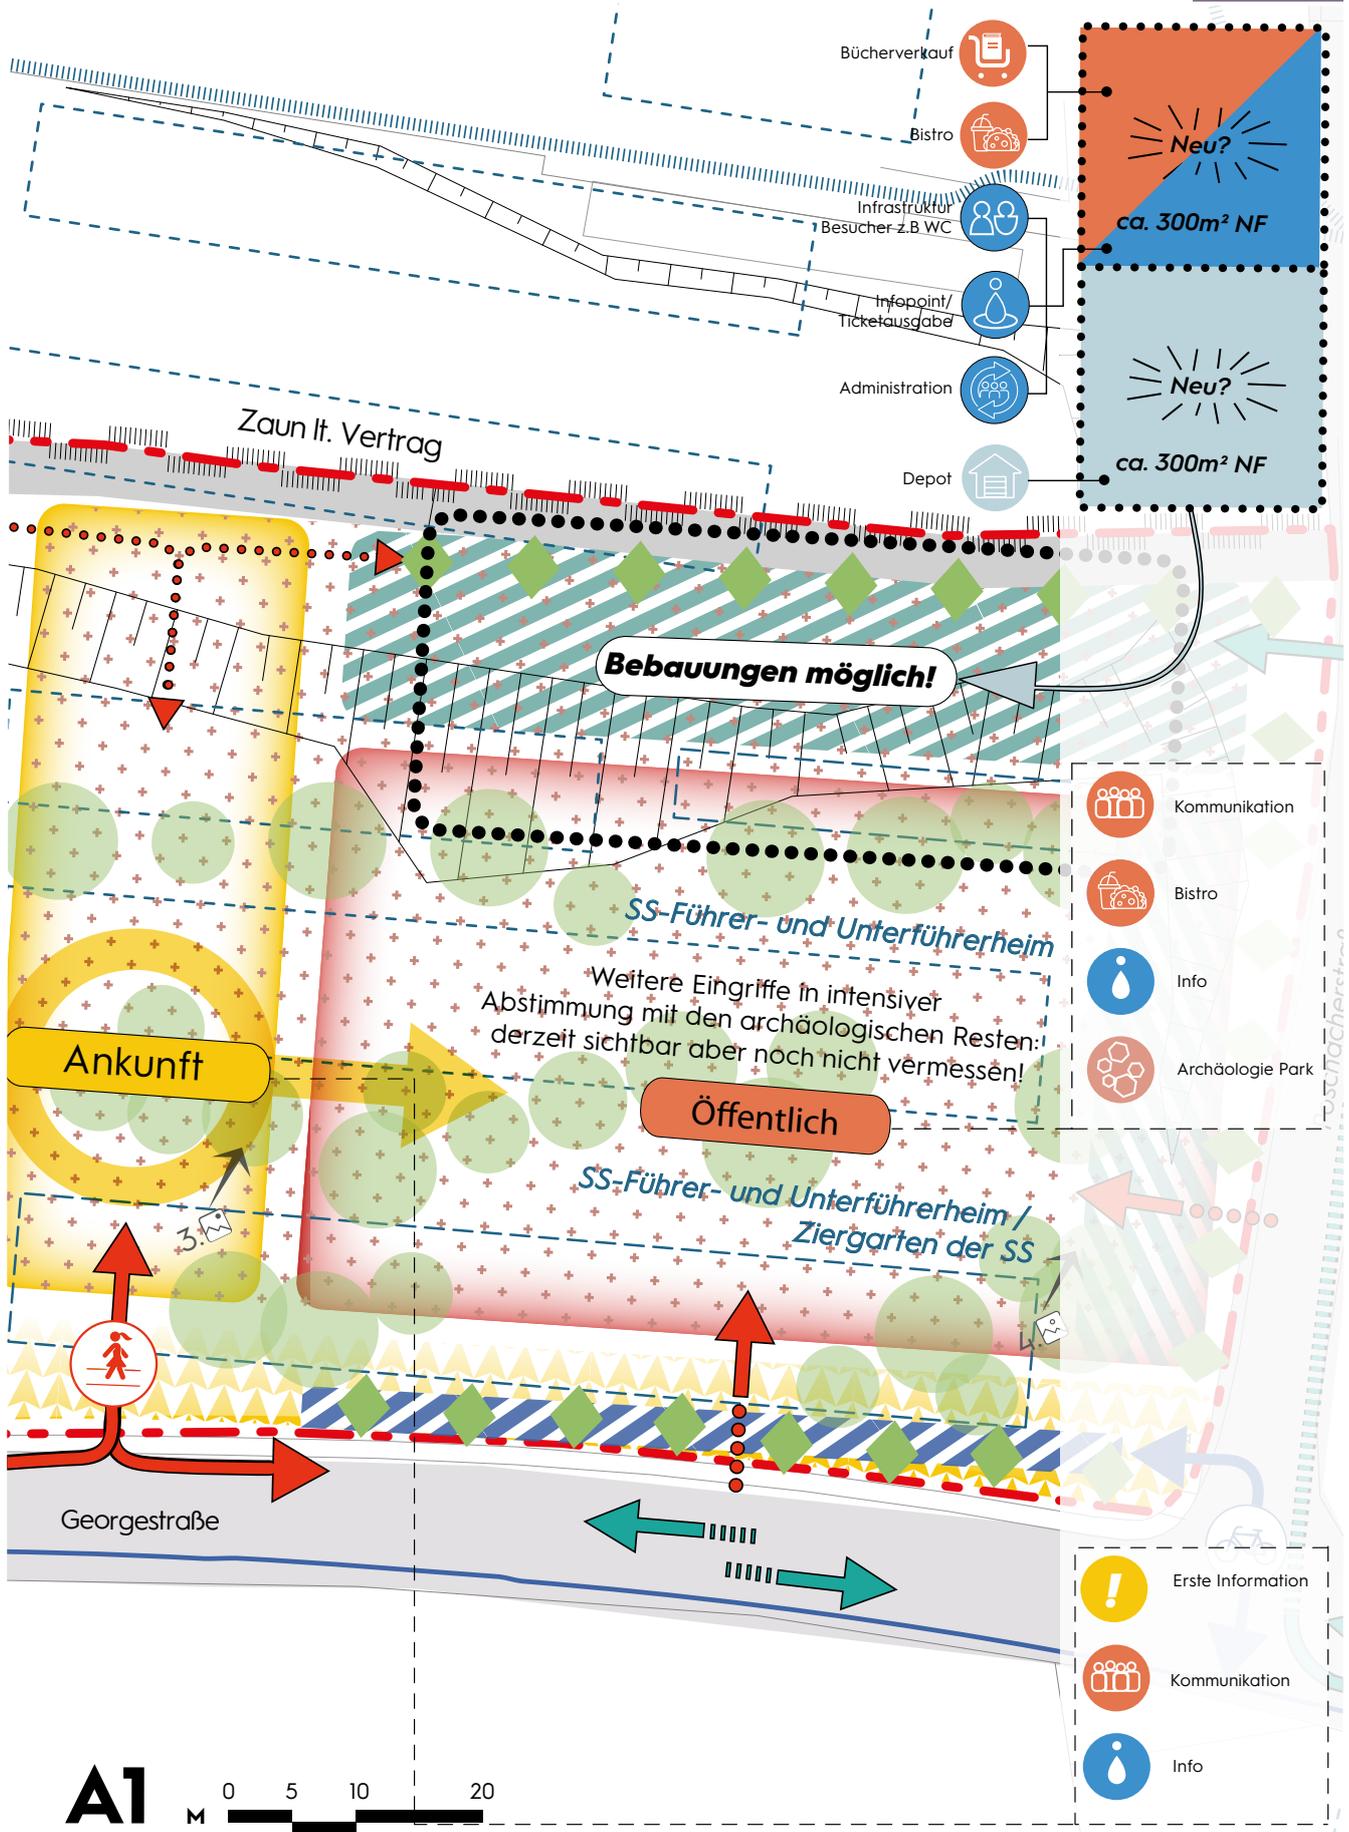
Masterplan Grundriss Appellplatz (Ausschnitt A1)
